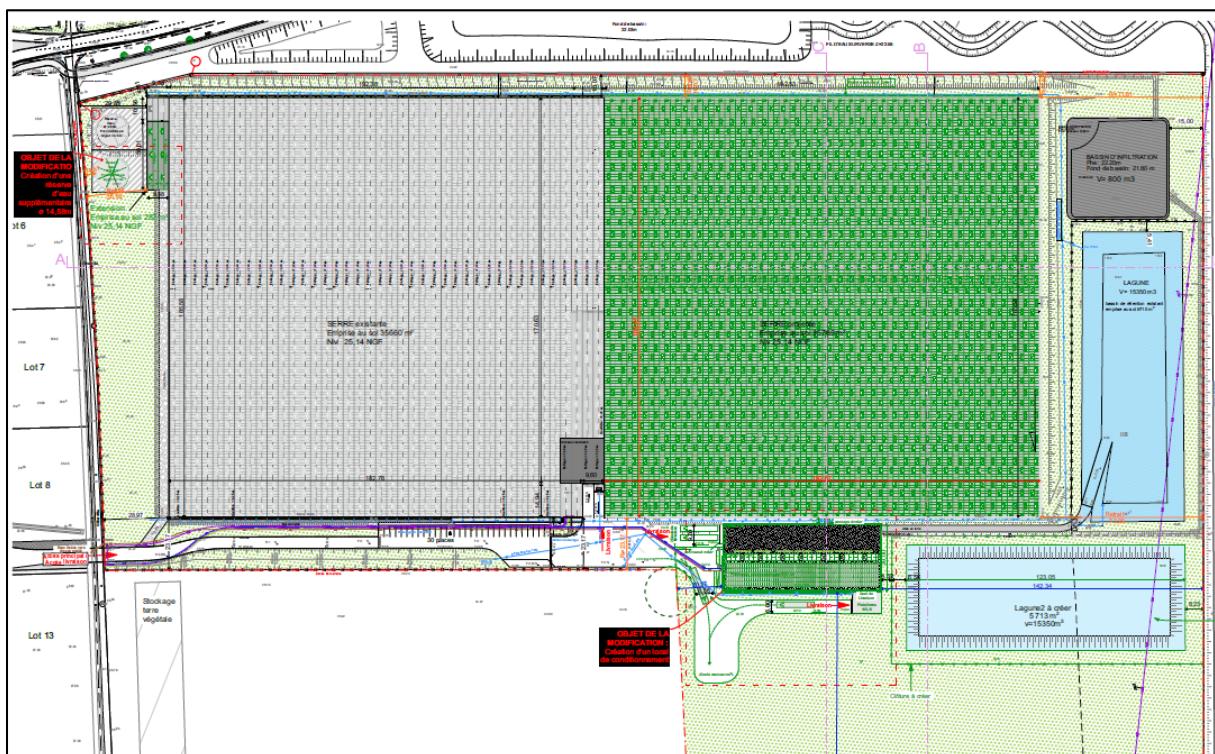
Plan du projet PC 014 167 24 P0006 M01 (source : plan de masse)
